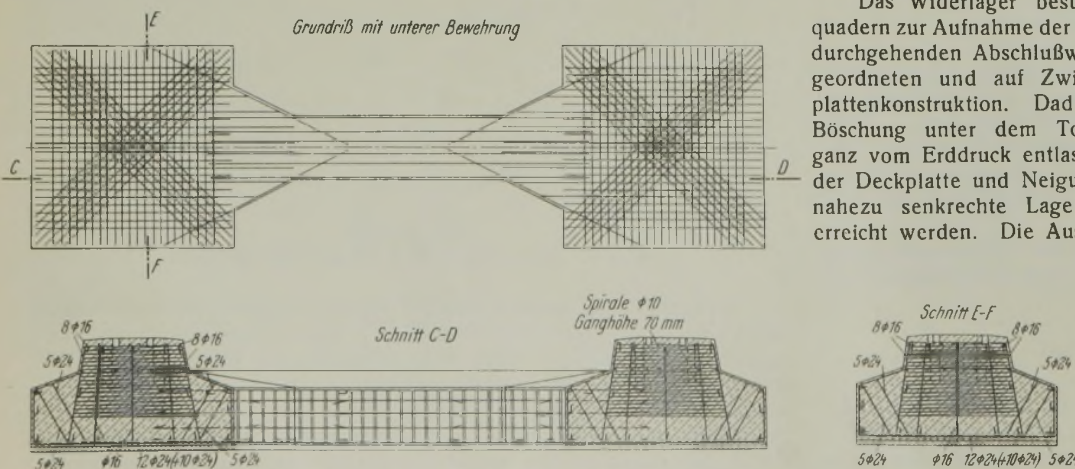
Bewehrung der Lager- und Grundkörper für die Zwischenstützen.
